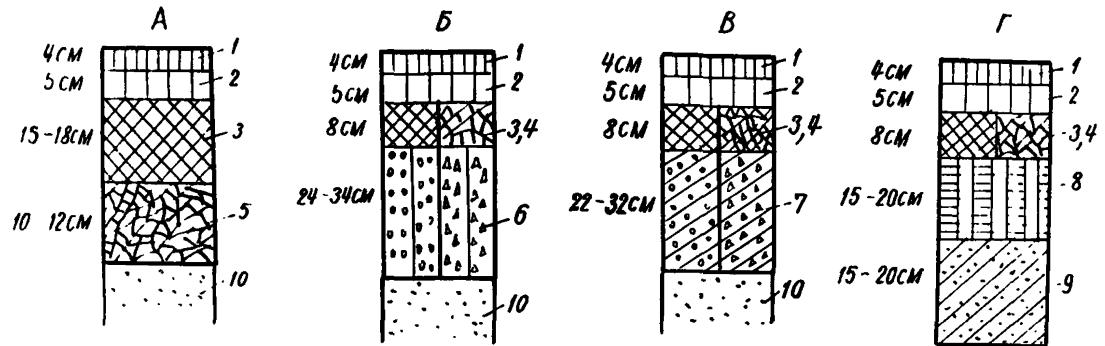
Типы конструкций дорожных одежд с асфальтобетонным покрытием для дорог с тяжелым движением:
